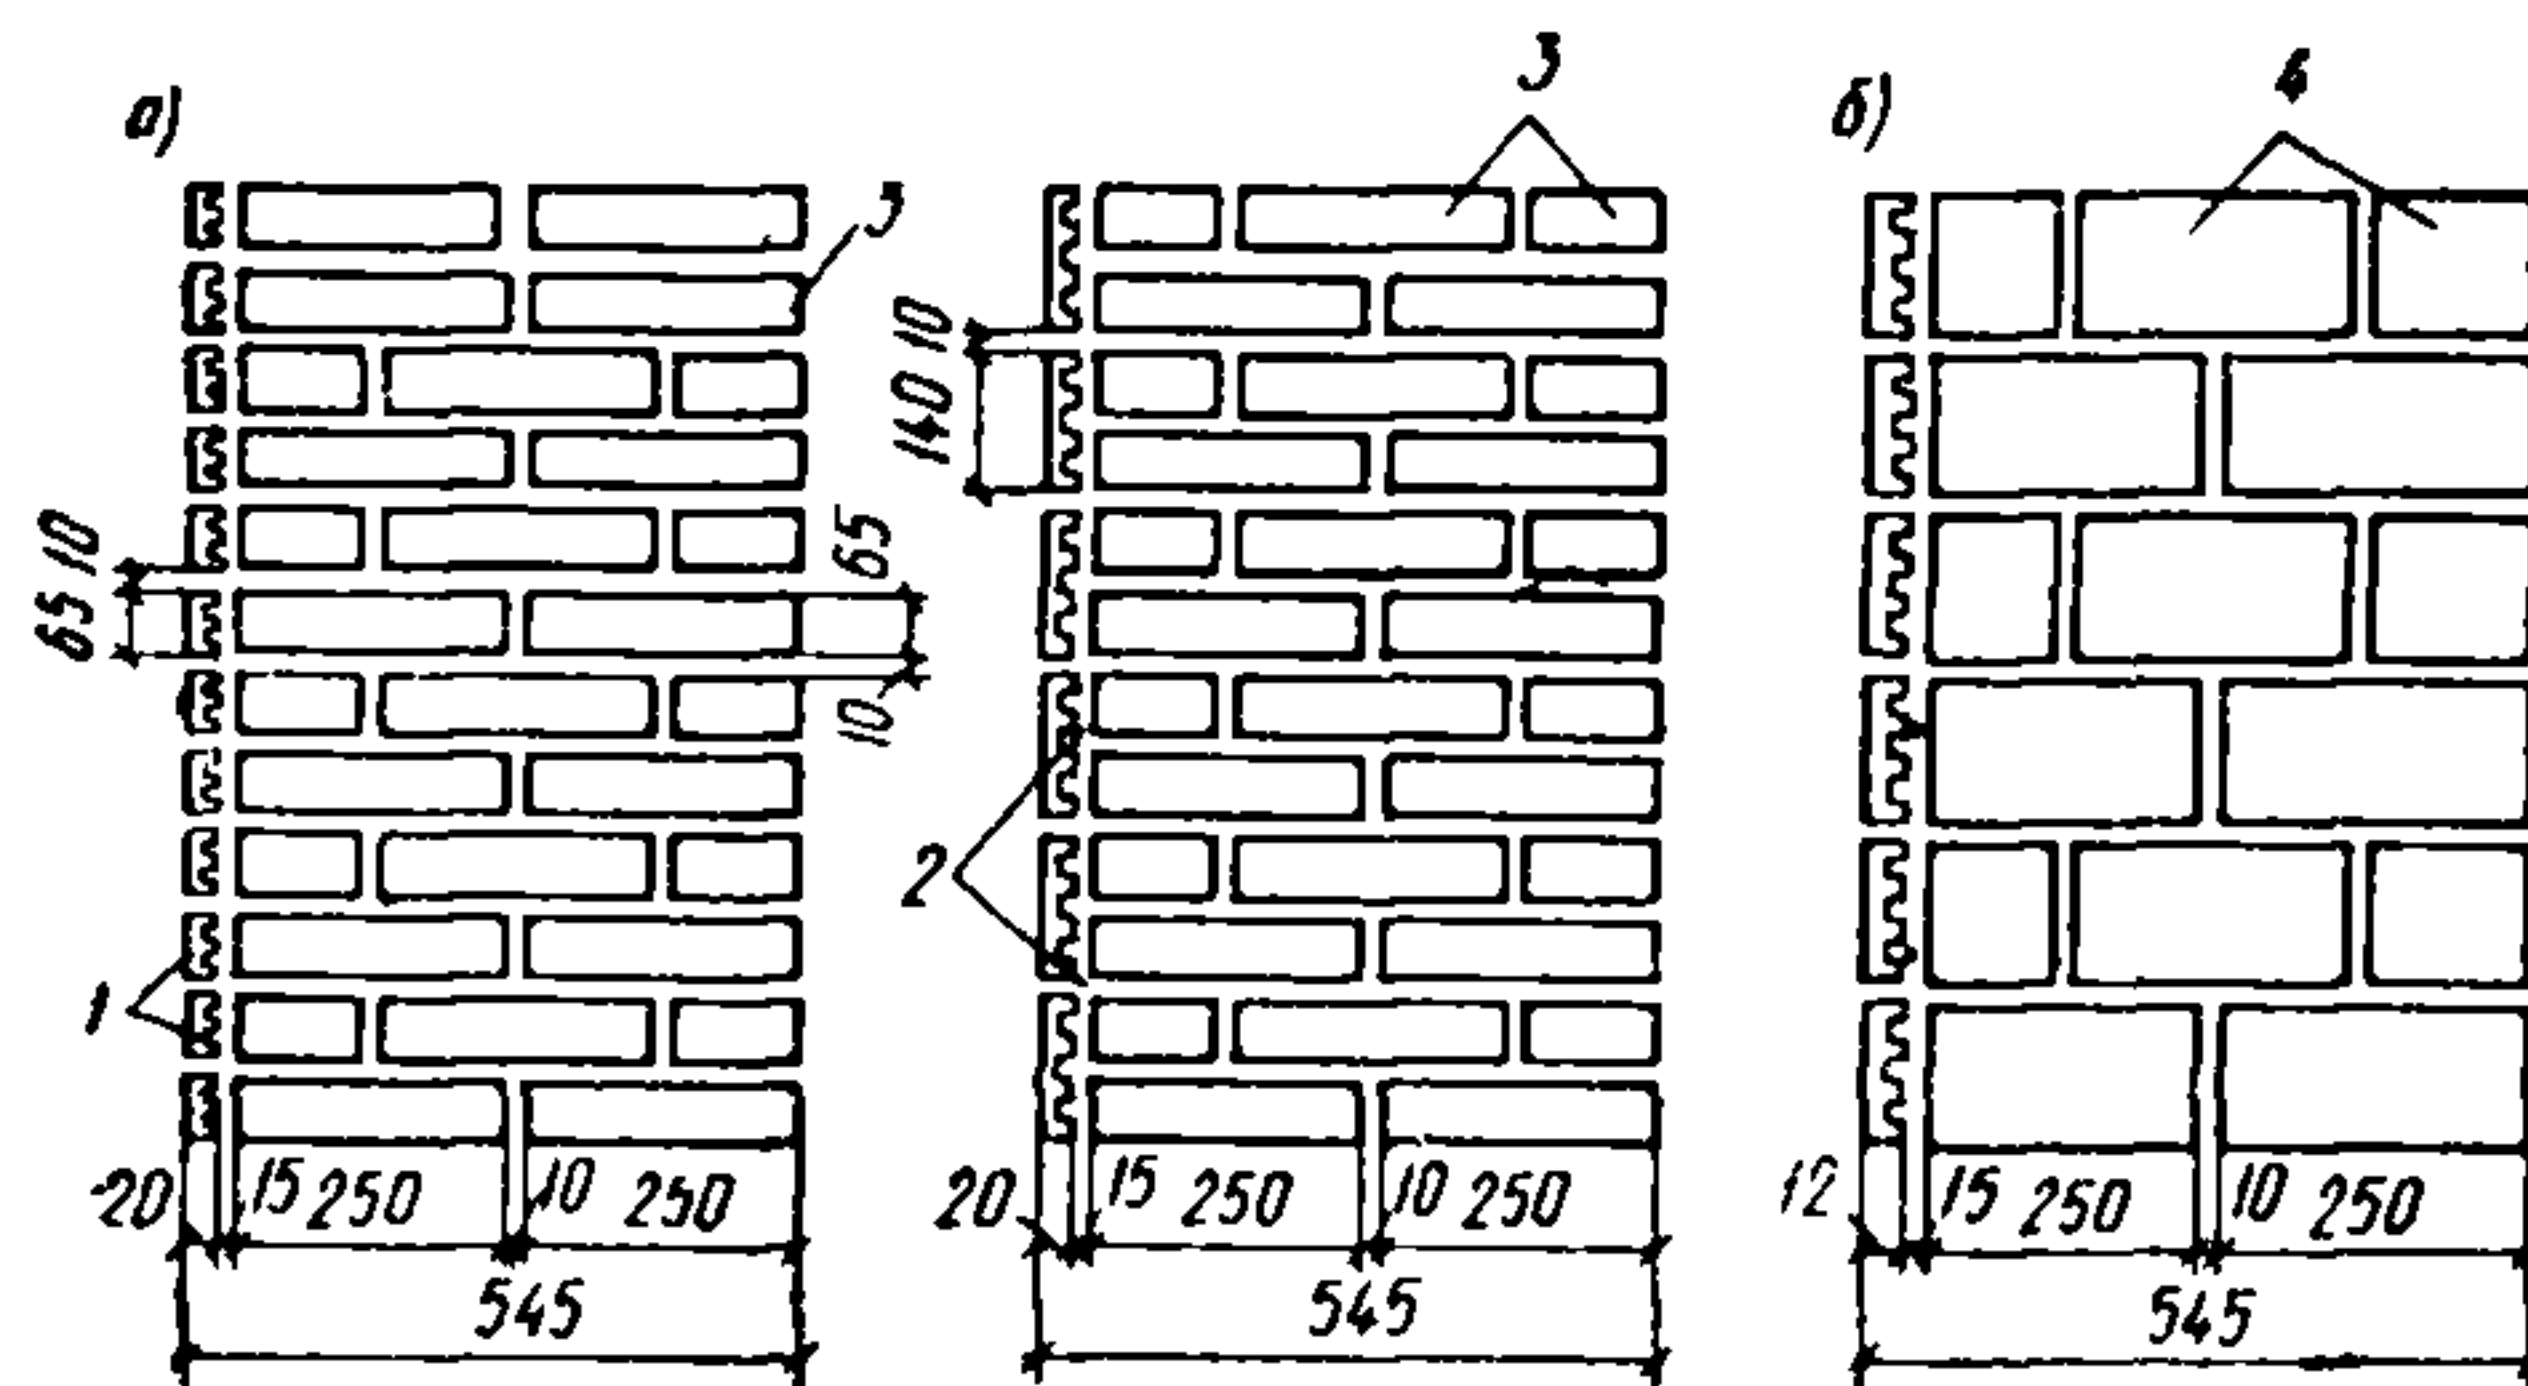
Облицовка кладки прислонными керамическими плитками с креплением на растворе
